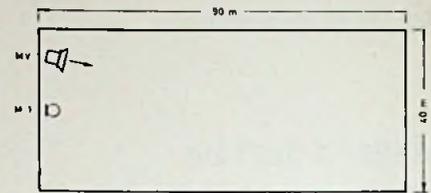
Grundriß der Werkhalle mit Zentralbeschallung
